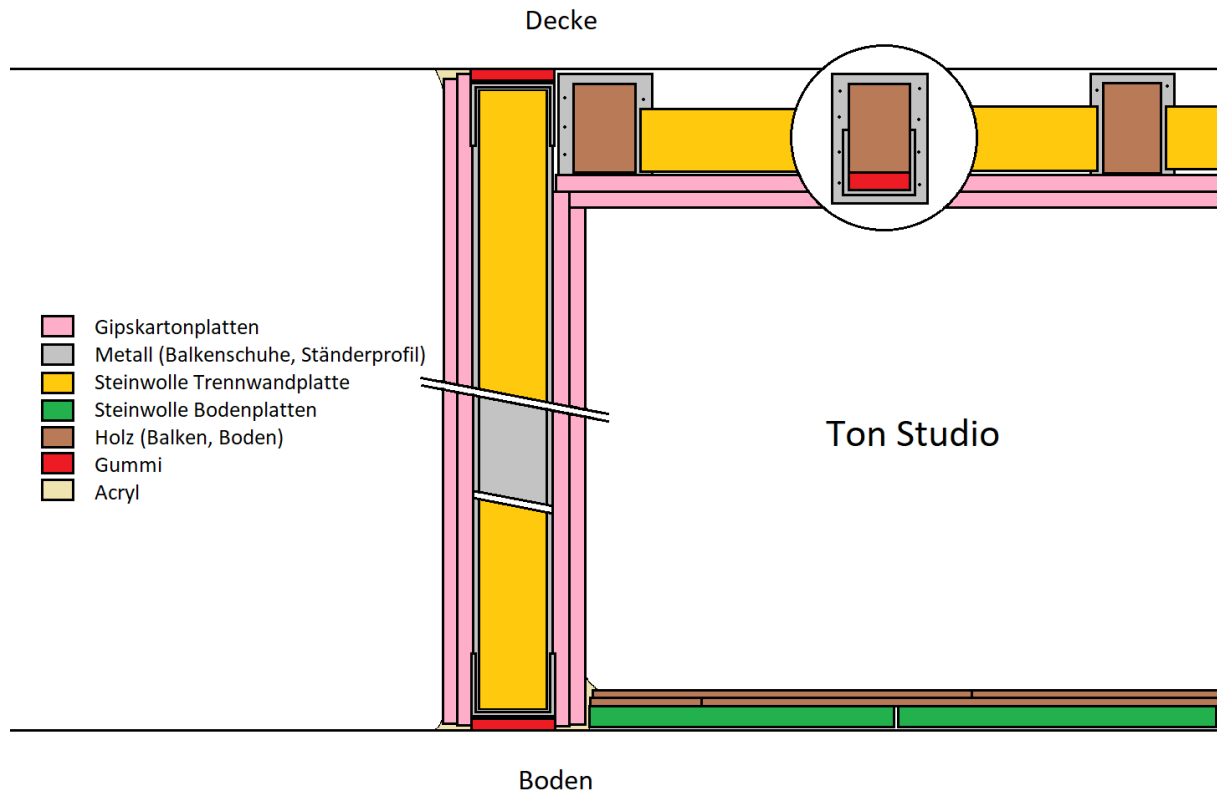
Bauplanskizze Schallisolierung und Entkopplung
